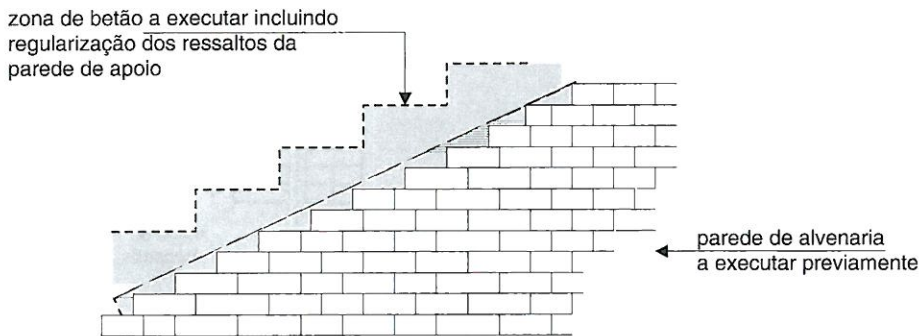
Apoio de escada de betão armado em parede de tijolo
